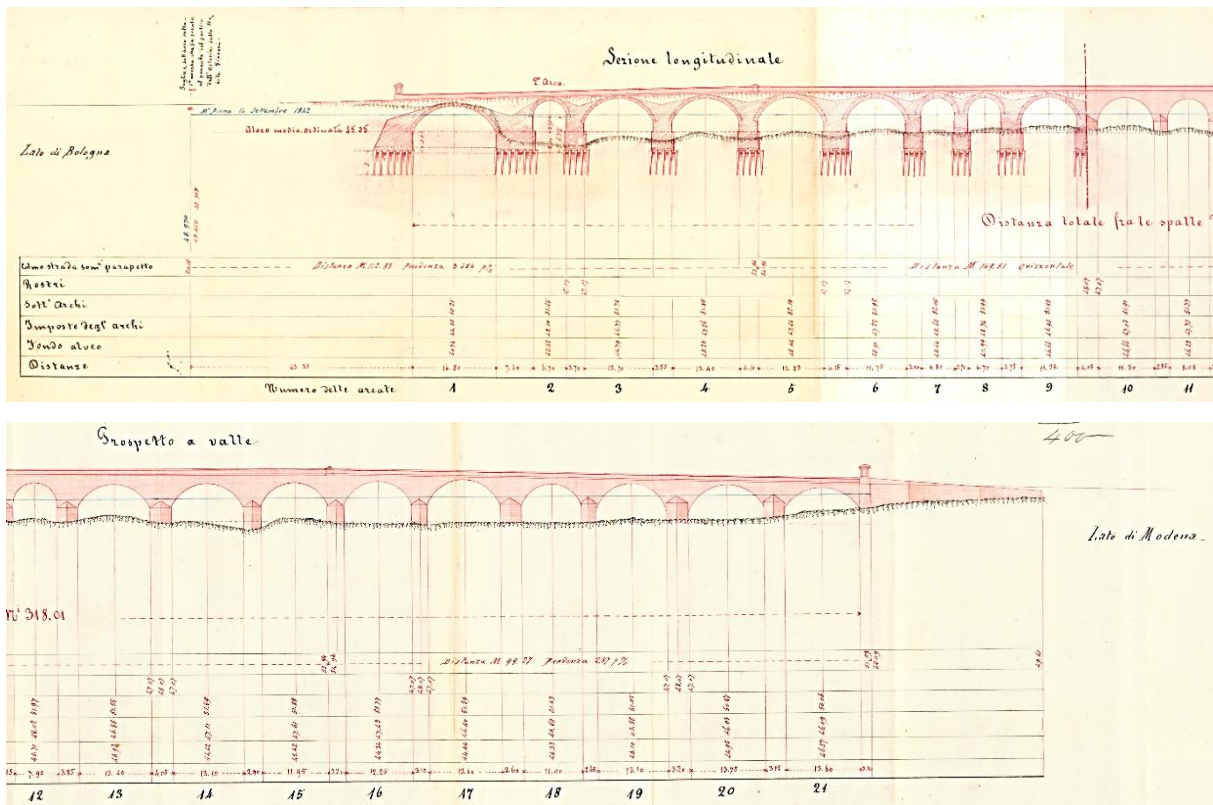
Sezione longitudinale e prospetto di valle del Pontelungo secondo il progetto del Panighi [169]. Si osservi che la numerazione delle arcate corrisponde a quella convenzionale adottata.
